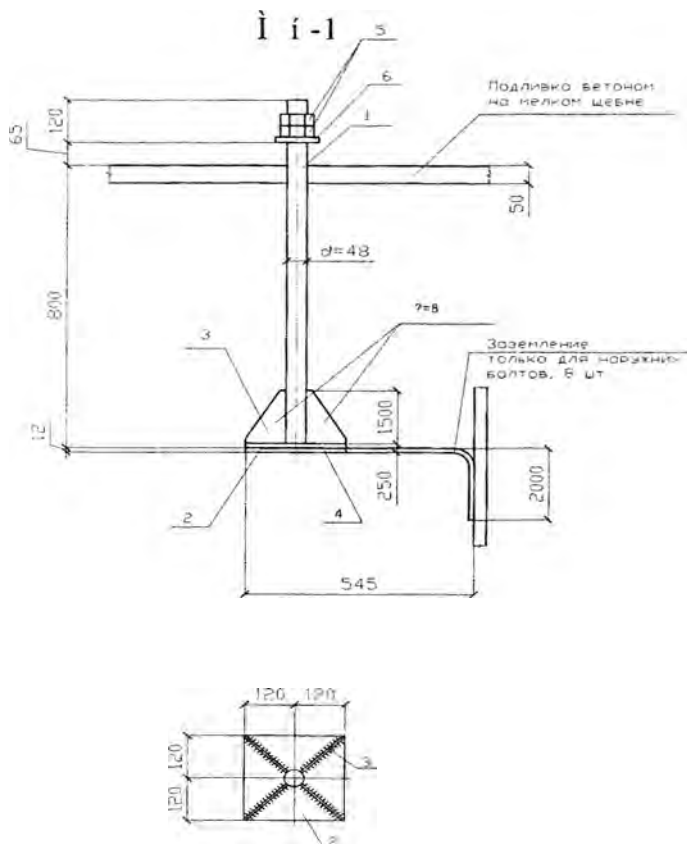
Конструкция анкерного болта, сопрягающего устье ствола с опорной плитой балки Б1
